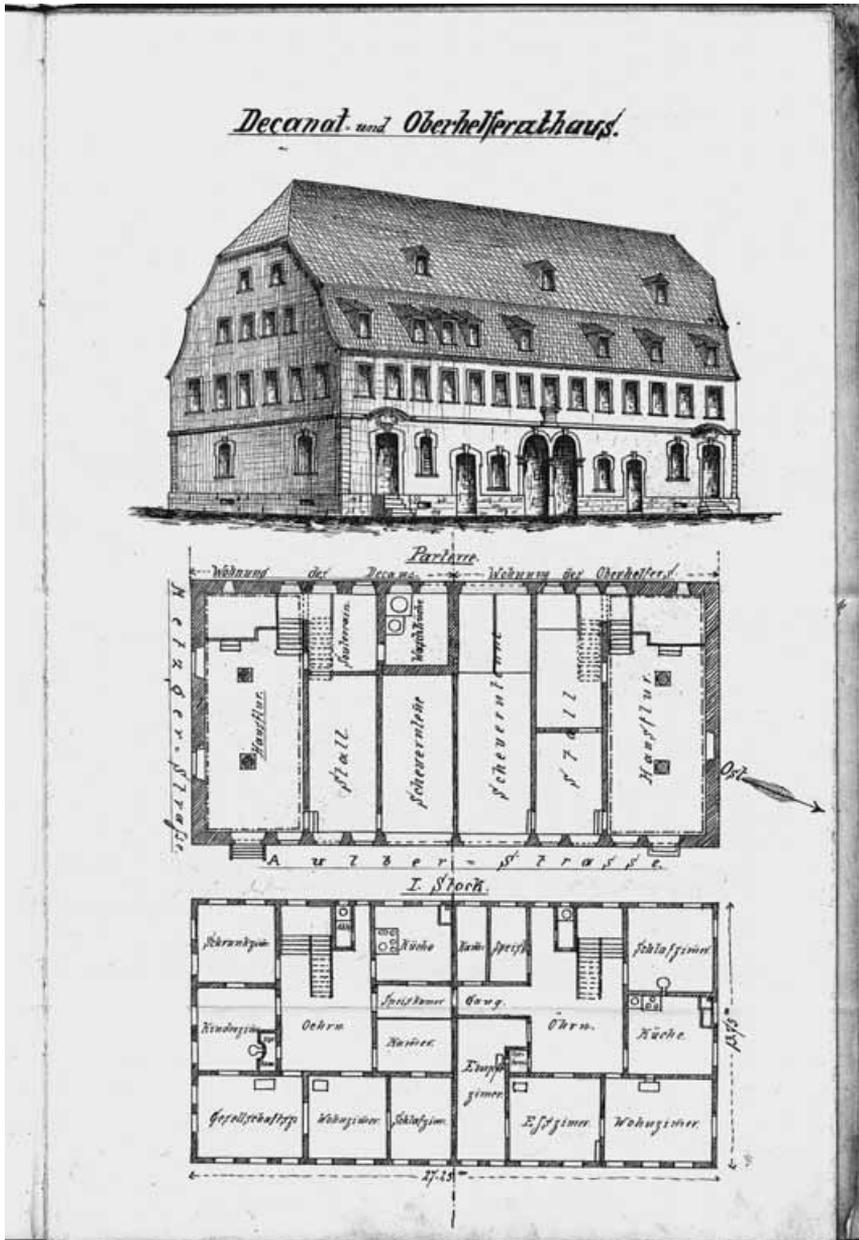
Aulberstraße 1, Planbeilage aus der Baubeschreibung von 1878, Südansicht sowie Grundrisse Erdgeschoss und Obergeschoss.
